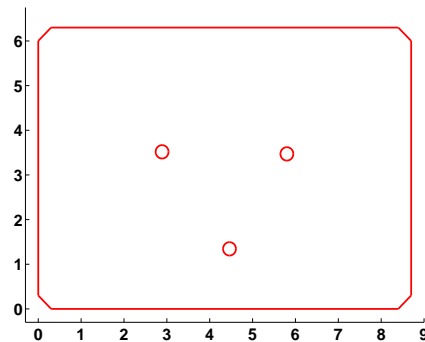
Grundriss der Zeltdachkonstruktion
